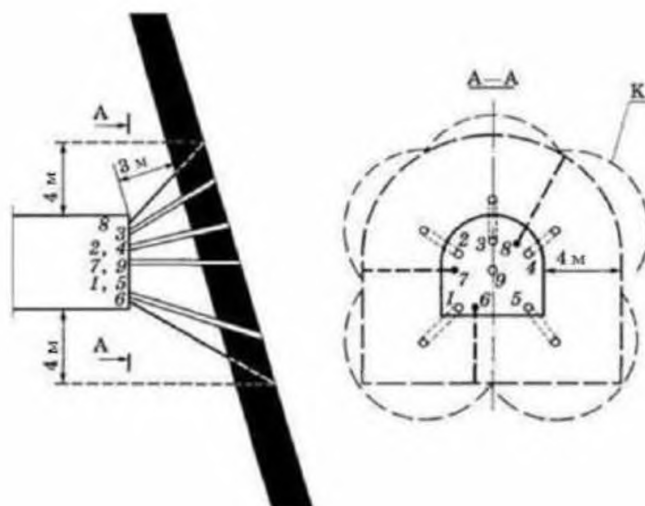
Схема расположения скважин для гидрорыхления угольного пласта при вскрытии угольного пласта крутого залегания:
